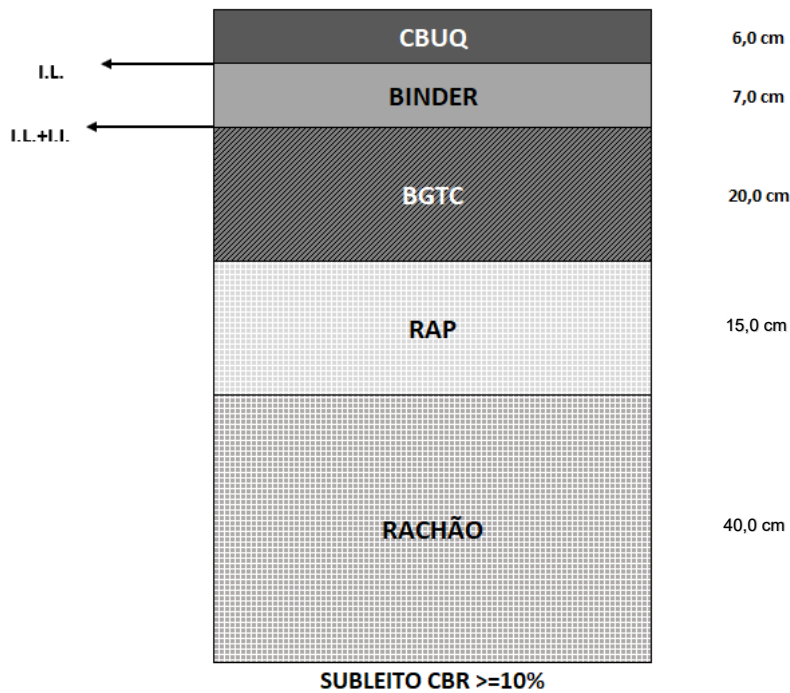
Esquematização da estrutura do Pavimento Tipo II – Semirrígido.
